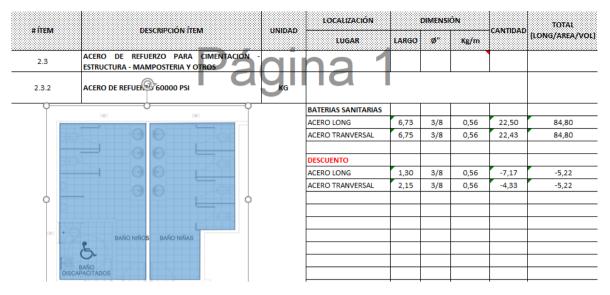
Cálculo de Cantidades de acero de refuerzo para losa de contrapiso.
